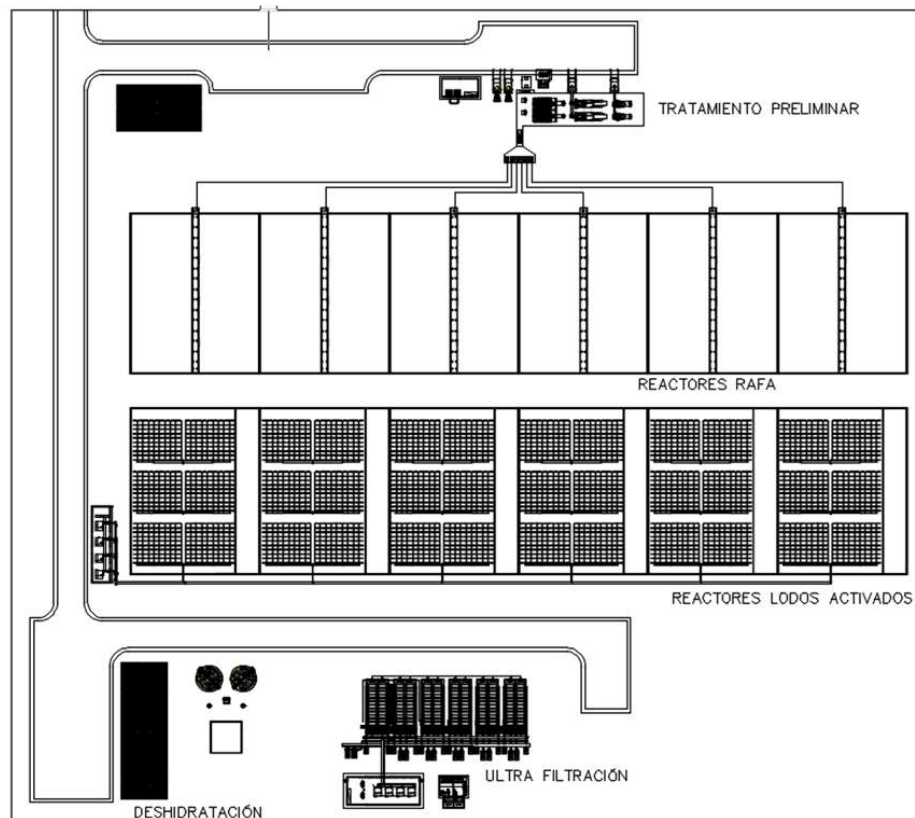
Planta de Tratamiento ubicada en Punta Cana
